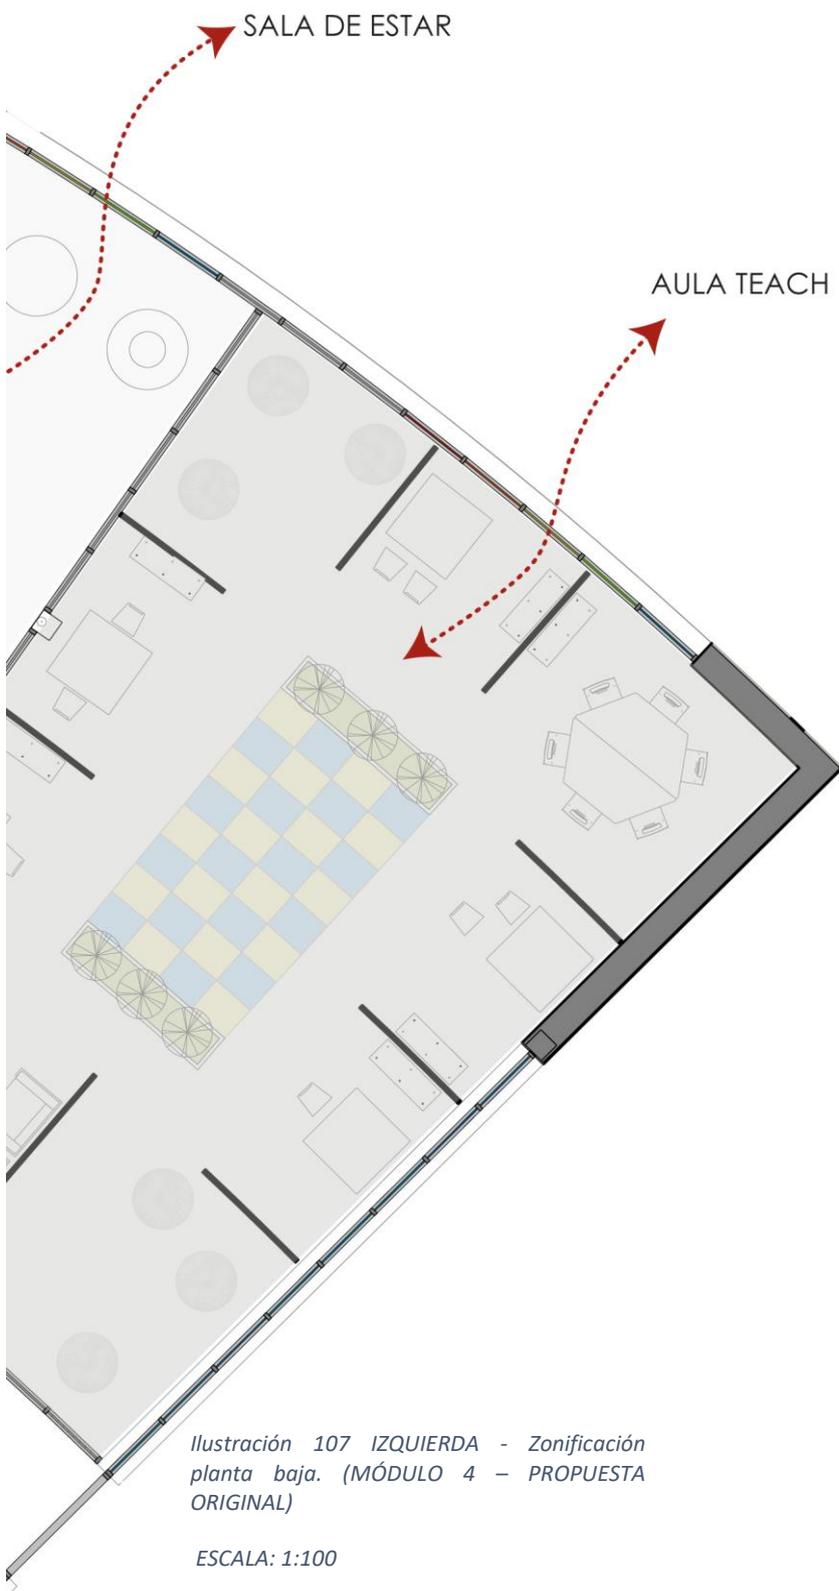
IZQUIERDA - Zonificación planta baja. (MÓDULO 4 - PROPUESTA ORIGINAL)
